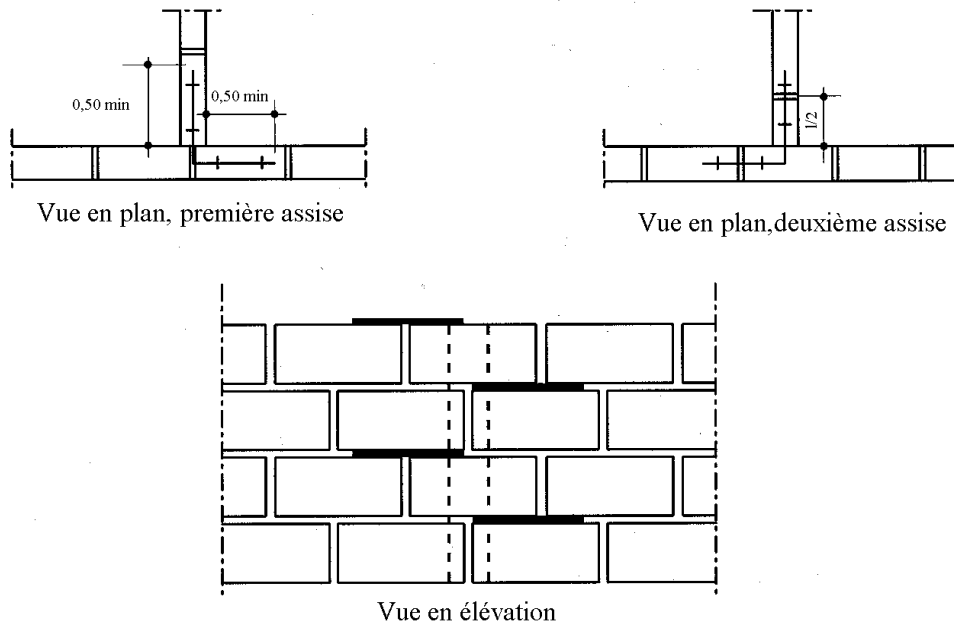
Jonction d'un mur porteur et d'une cloison en matériaux facilement clouables. Armature de ϕ 6mm clouées pliées à gauche et à droite. (NBN ENV 1996-1-1 NAD, 2002)
